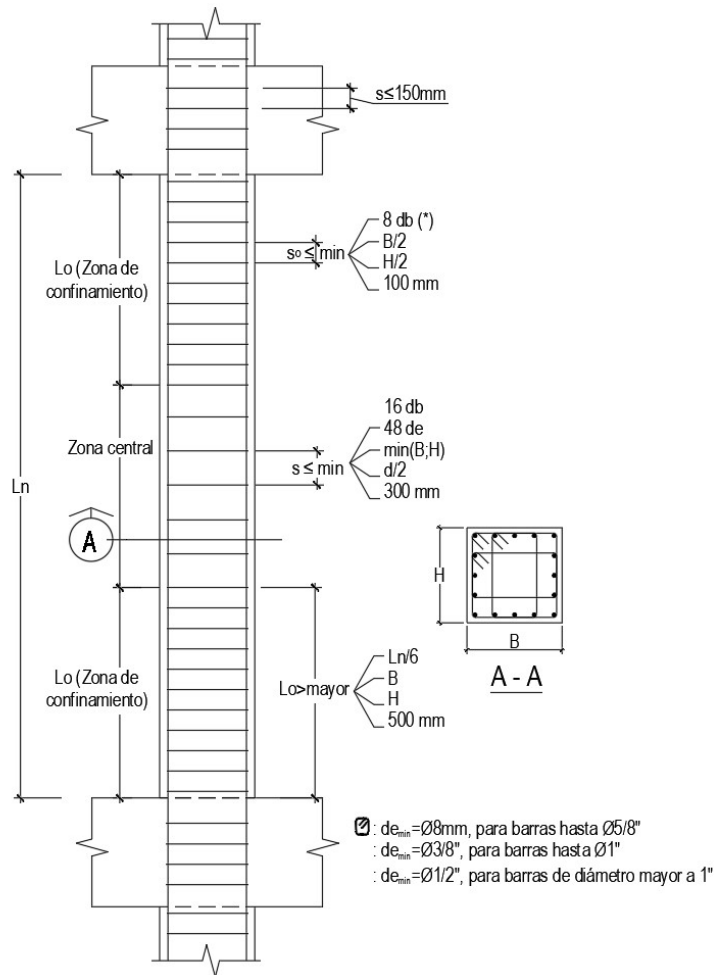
Distribución de estribos en columnas para sistemas de Muros y Duales Tipo I
